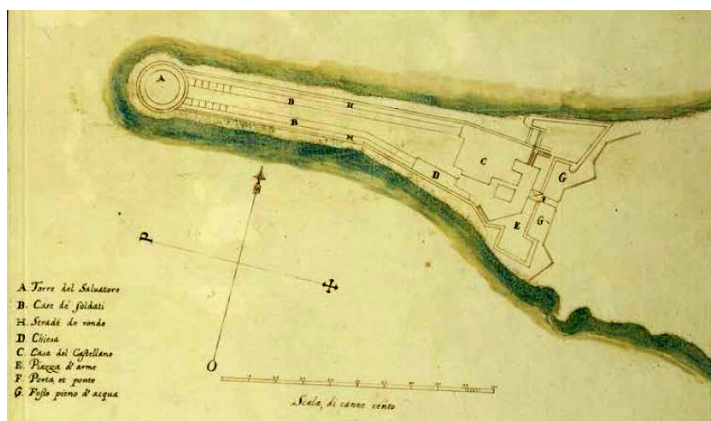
Pianta del Forte del SS.Salvatore [11]
